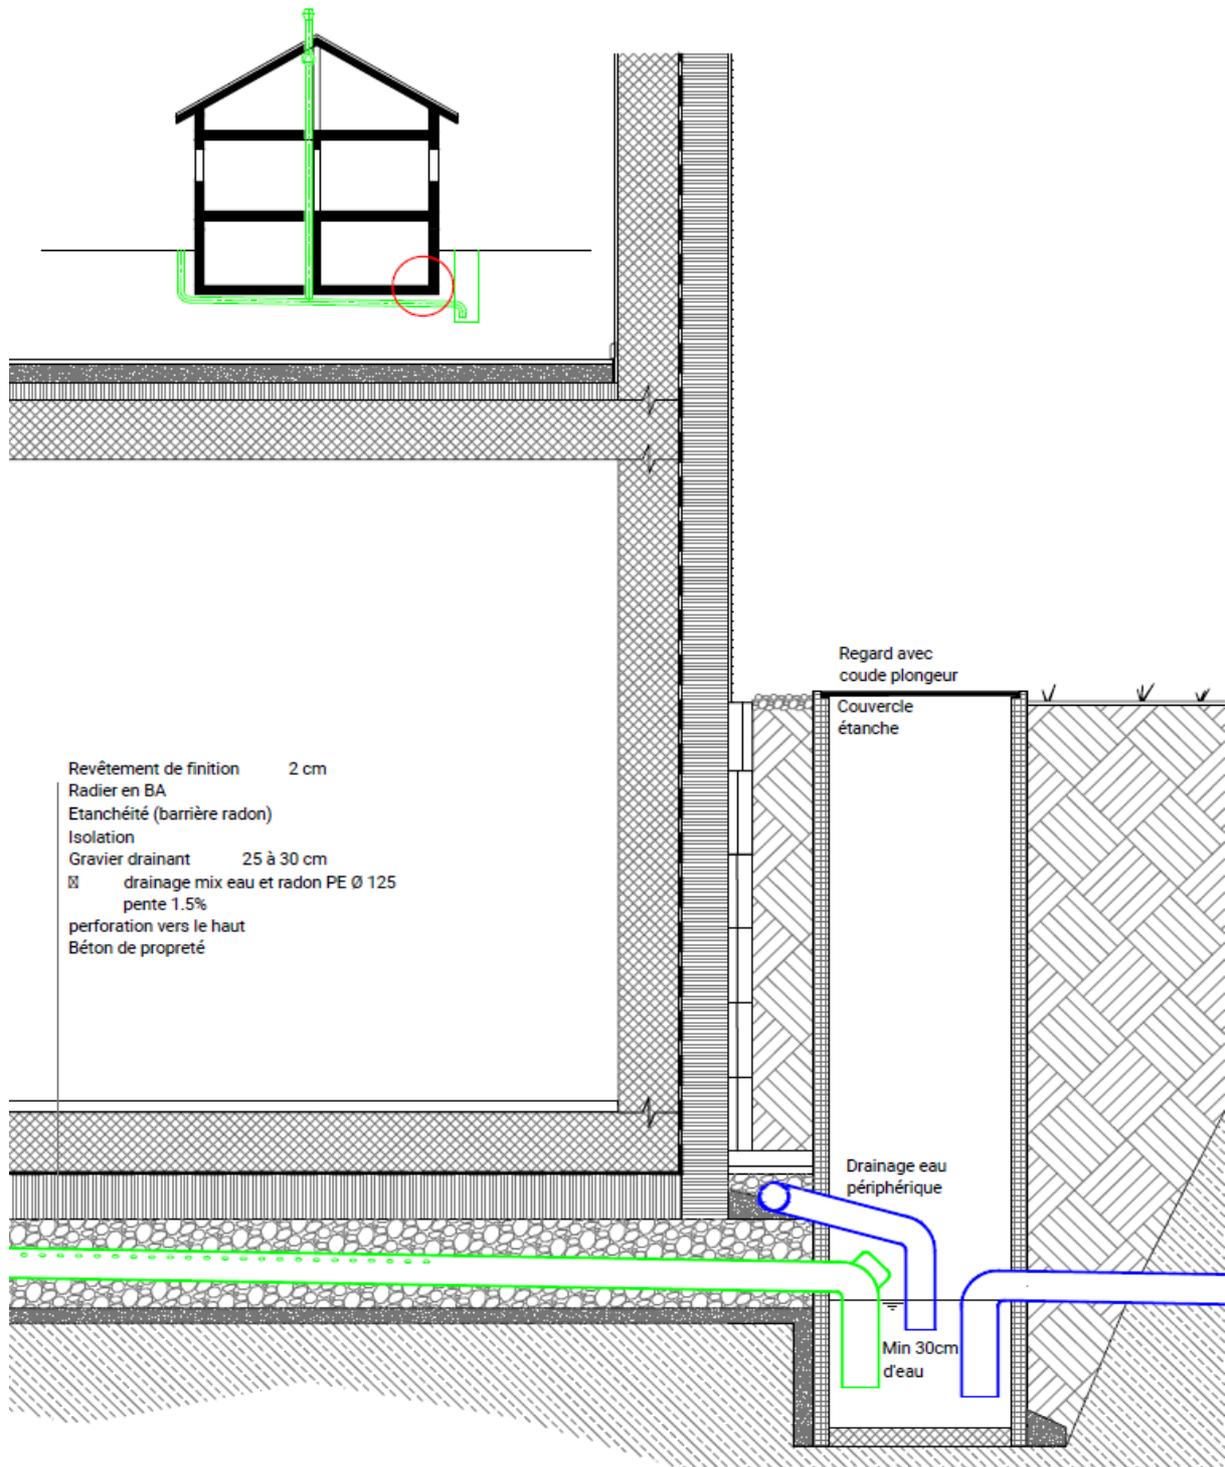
Détail en coupe d'un drainage mixte radon + eau (détail : croqAIR, HEIA-FR, source : ECONS SA)
